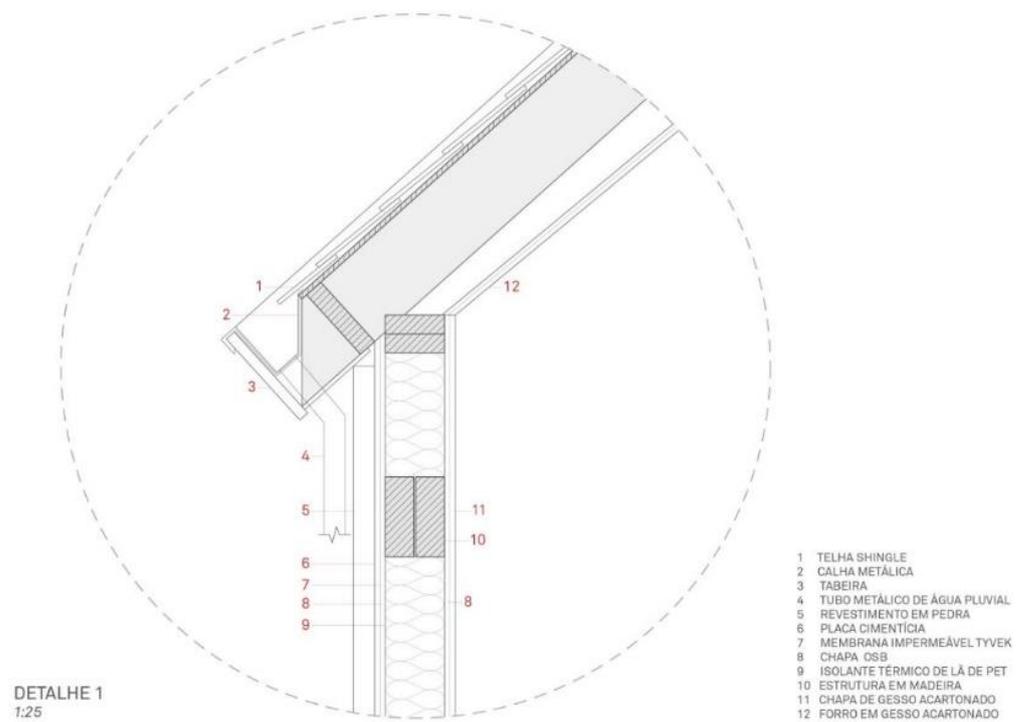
DETALHE DO ENCONTRO DO TELHADO COM A PAREDE
